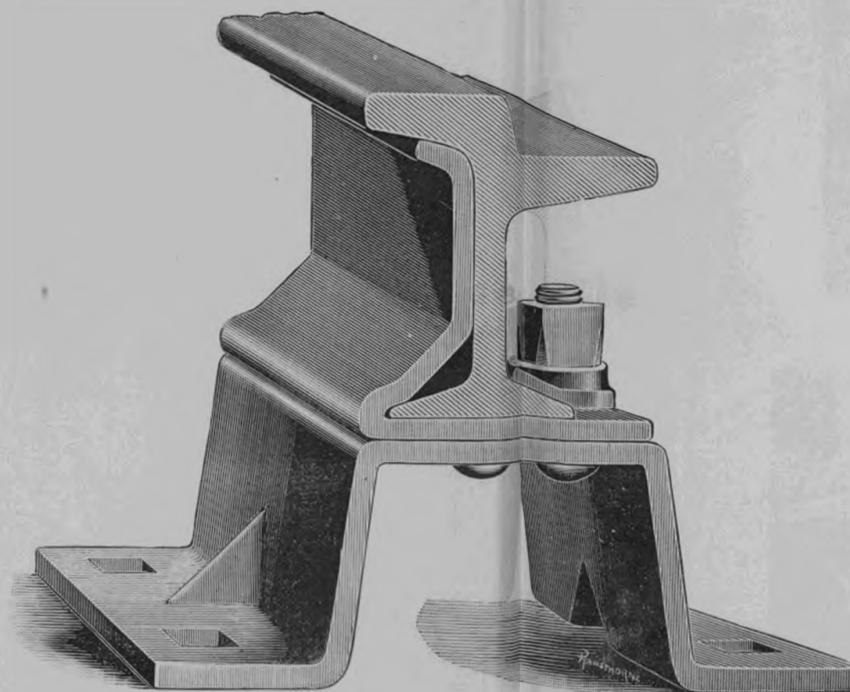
RAIL DE TRAMWAY POUR POSE DE VOIE DANS UNE CHAUSSÉE PAVÉE (AVEC SUPPORT EN TOLE EMBOUTIE)
